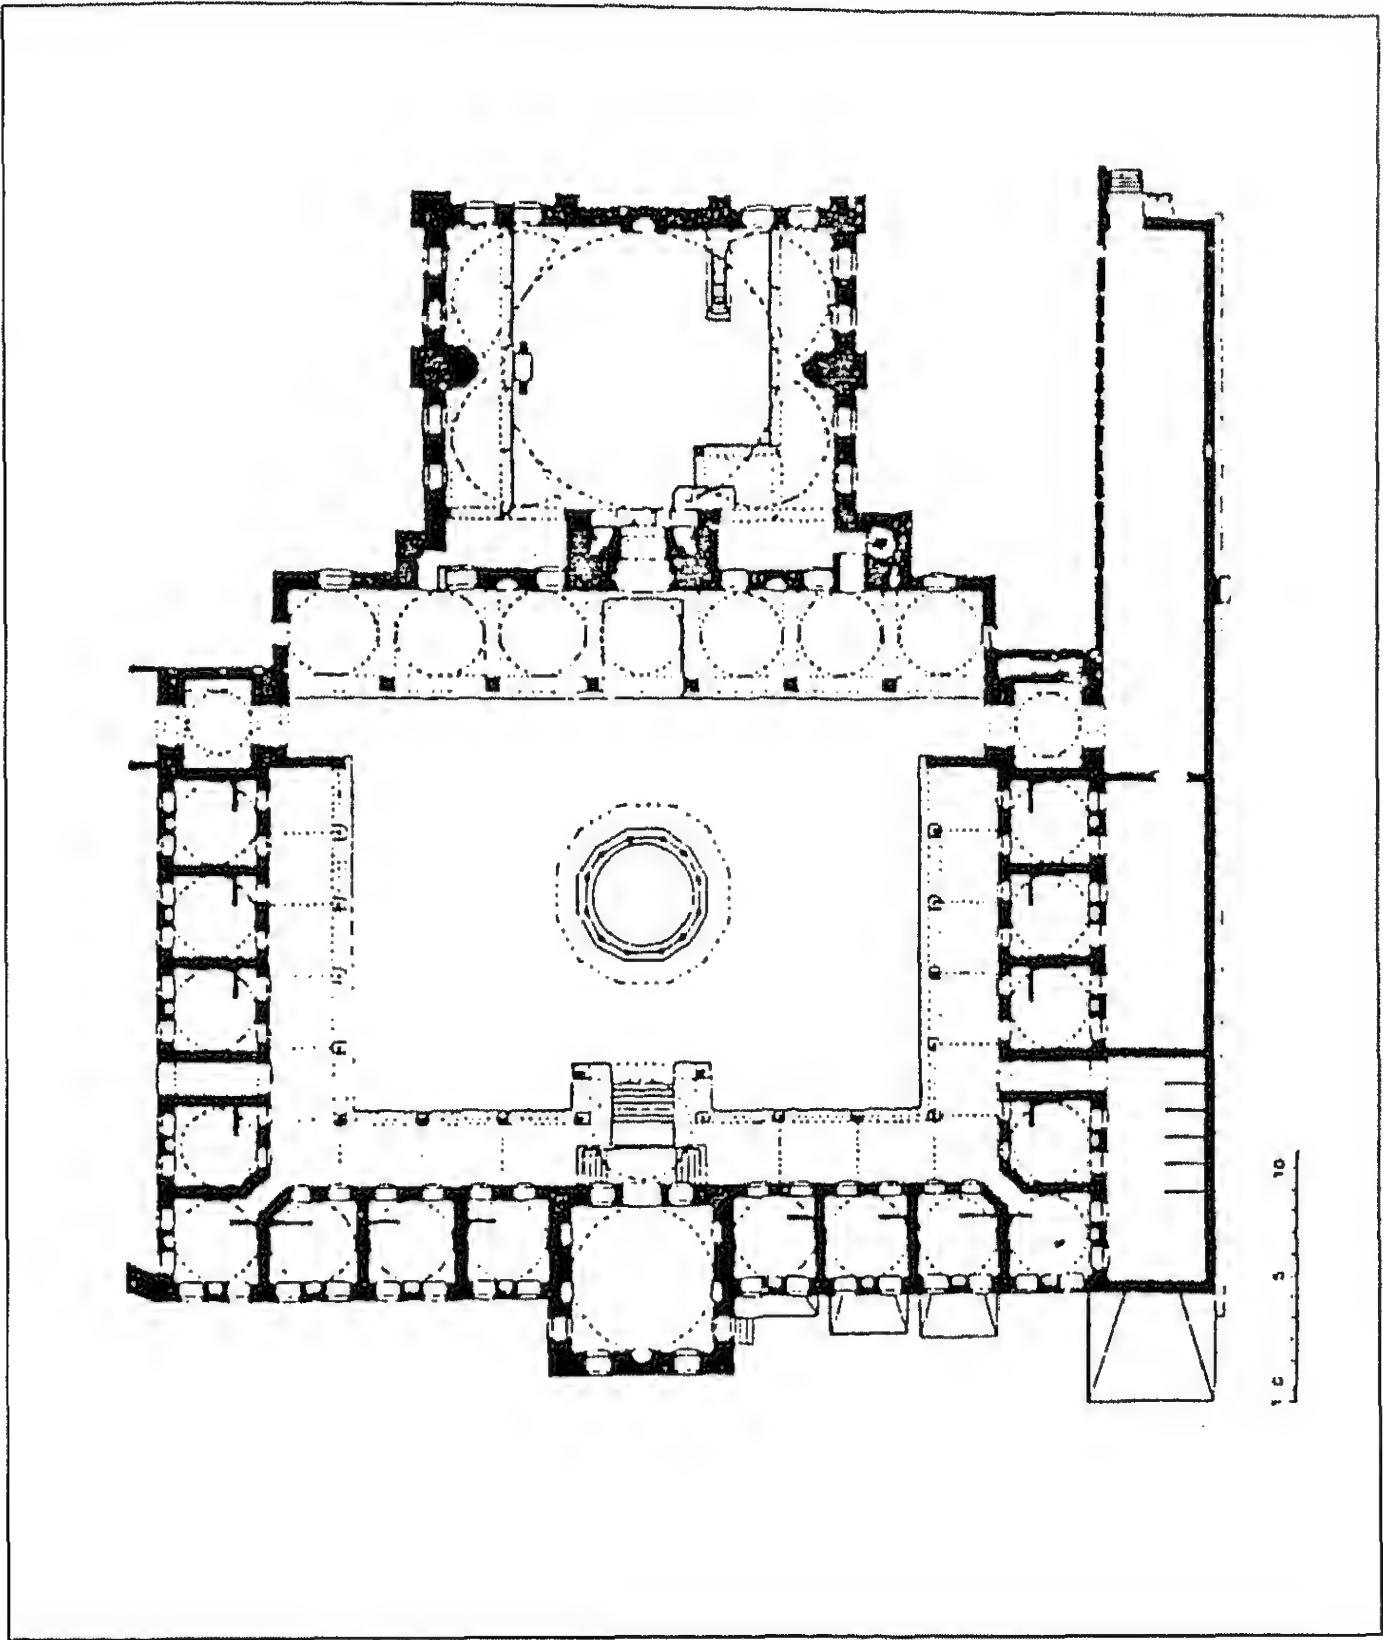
مسقط أفقي لمدرسة رستم باشا في استانبول (عن : كوران) .
